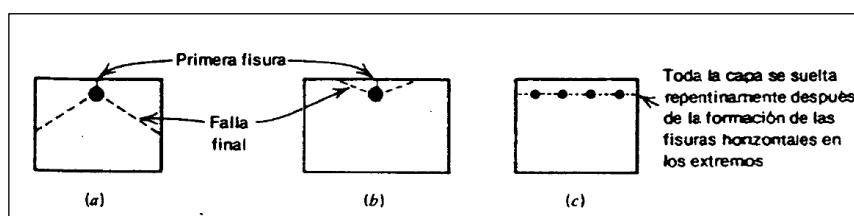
Grietas de rajadura en la falla (a) caso típico. (b) En vigas muy anchas. (c) con varillas espaciadas estrechamente. Fuente: Park y Paulay, 1975, p. 417.
